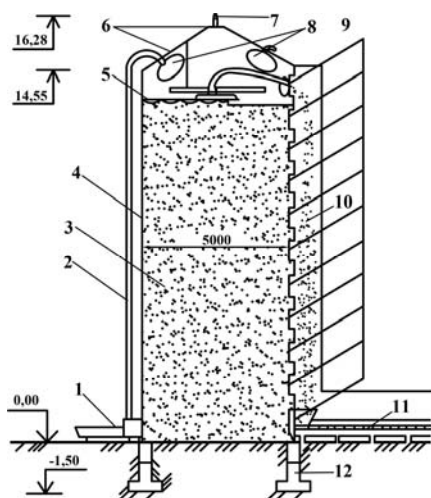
Металева герметична башта для сінажу з верхнім розвантаженням:
